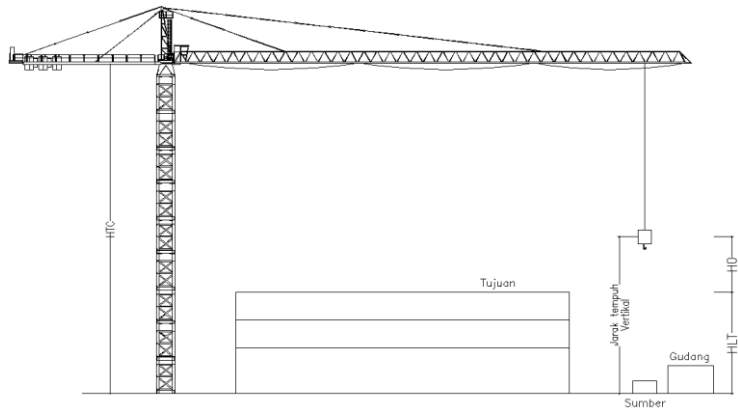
Ketinggian Tower Crane dan Gedung.
